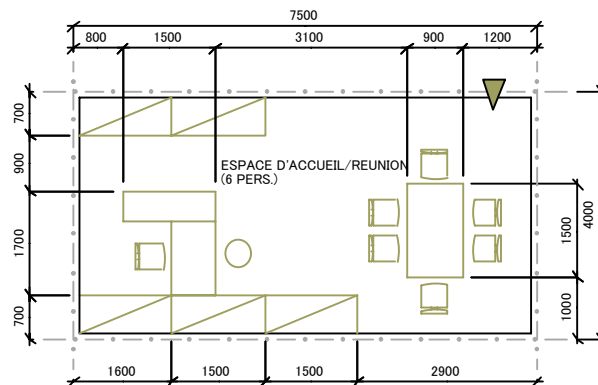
Plan planimétrique du bureau du directeur général du marché
